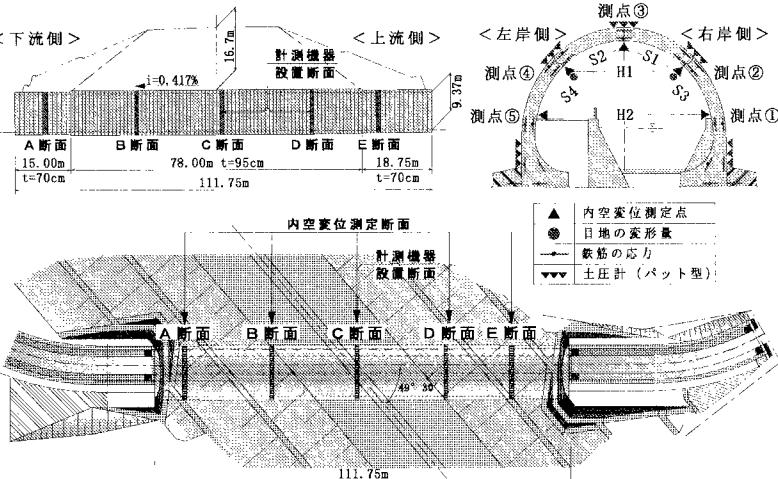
モジュラーアーチ縦断図・平面図・断面図
